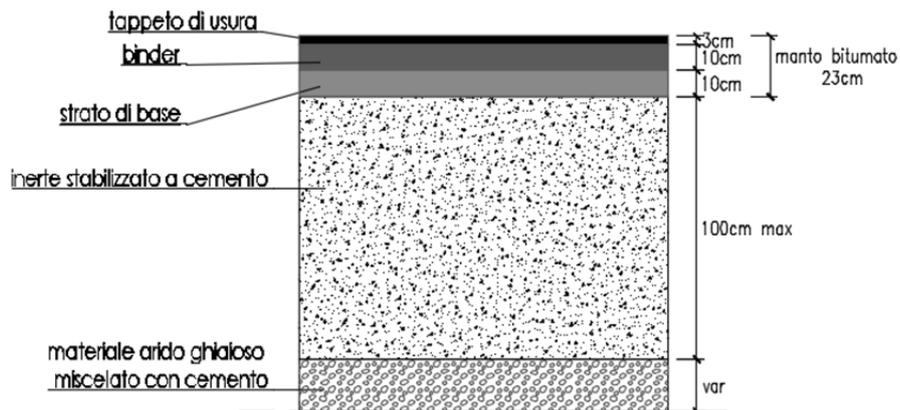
S.P. n.123 Poianese - Particolare del pacchetto stradale di ripristino
